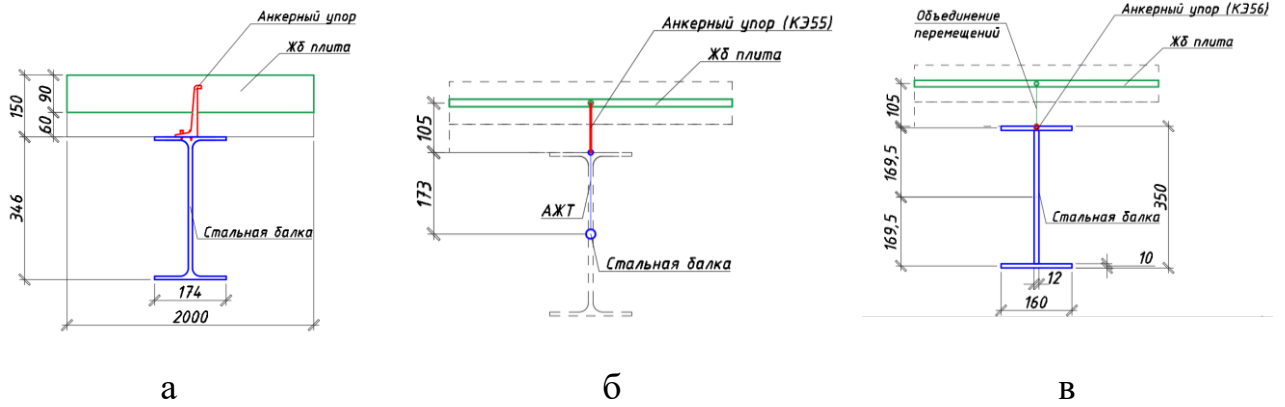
Вариант компоновки расчётной схемы сталежелезобетонного перекрытия: а – эскиз сечения; б – 1 вариант моделирования; в – 2 вариант моделирования
